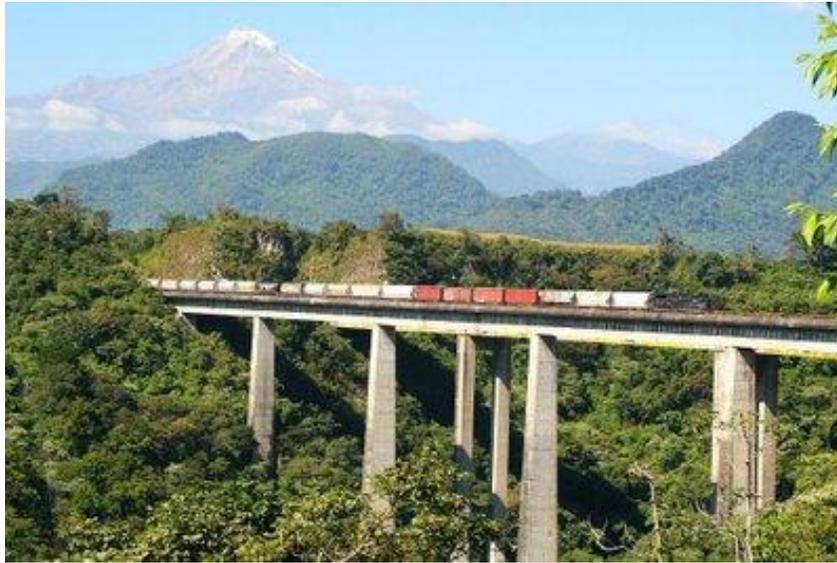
Puente Ferrocarrilero “Metlac” México-Veracruz
